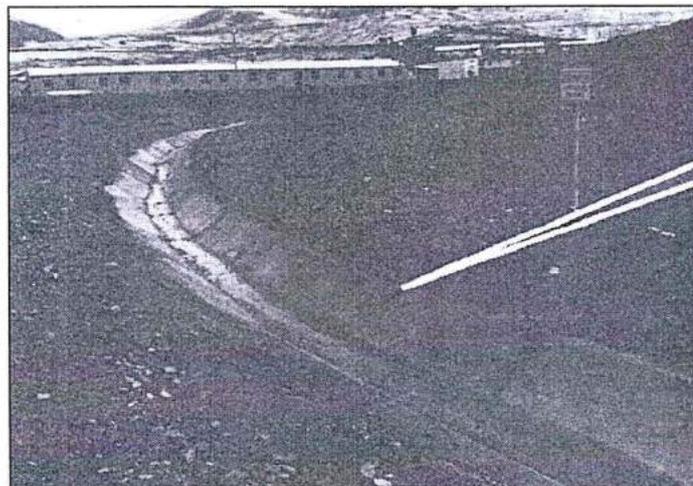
Vista Aguas abajo del canal de coronación de mampostería Con concreto lado sur.
